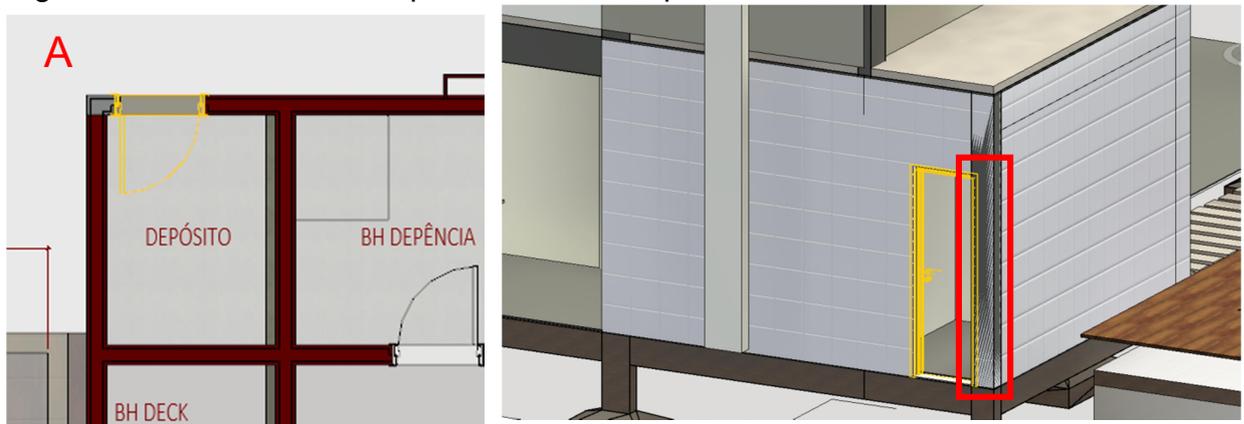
Interferência das portas com pilares ou vigas em planta baixa
